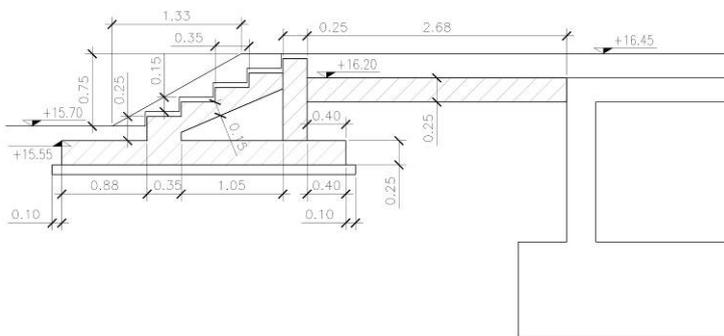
Sezione rampa pedonale di accesso all'edificio
